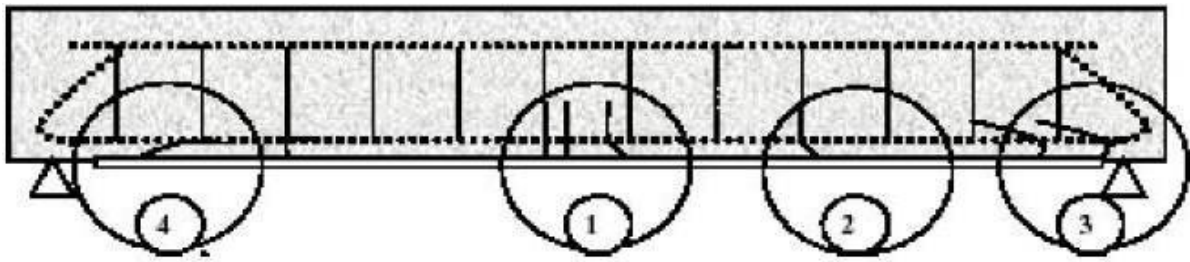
Comportement structural d'une poutre renforcée. (RABAHI,2016).
